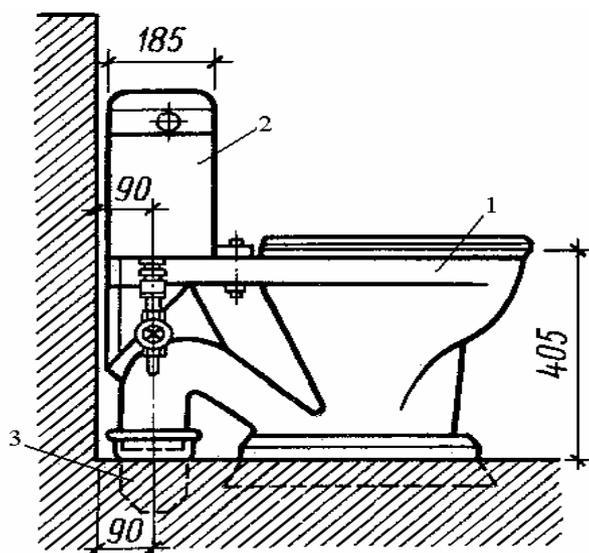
Присоединение унитаза с прямым выпуском к отводной трубе, проложенной в перекрытии.
